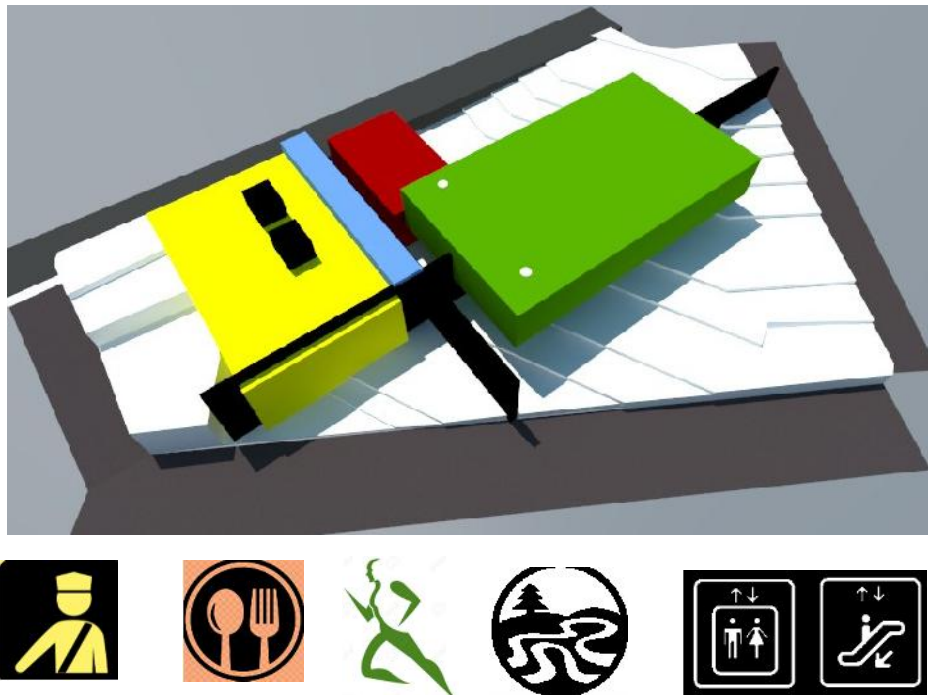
Plan masa planta baja, áreas recreativas, zona de entrenamiento, seguridad.
